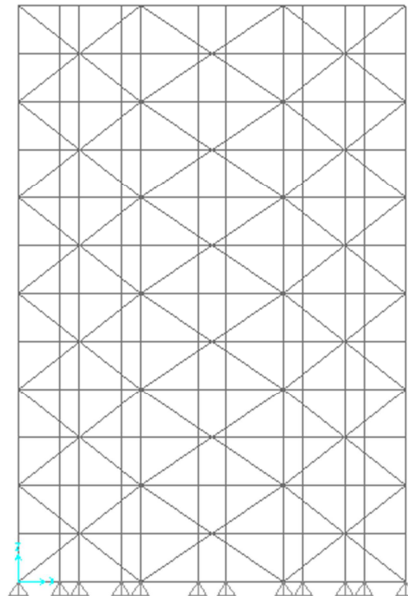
Configuração dos Planos de Contraventamento Vertical Com Elementos de Contraventamento Grandes
